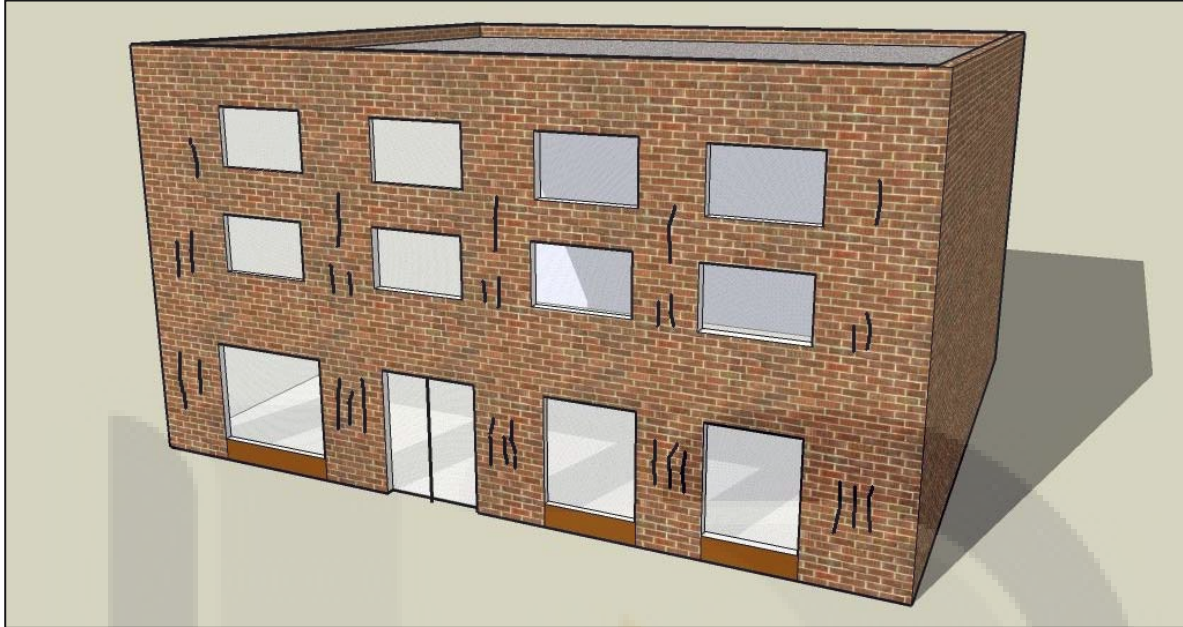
Fisuras que aparecen por efecto de diferencia en las solicitaciones soportadas en un mismo plano del edificio de mampostería. Adaptado de Genescà et al., 1997.
